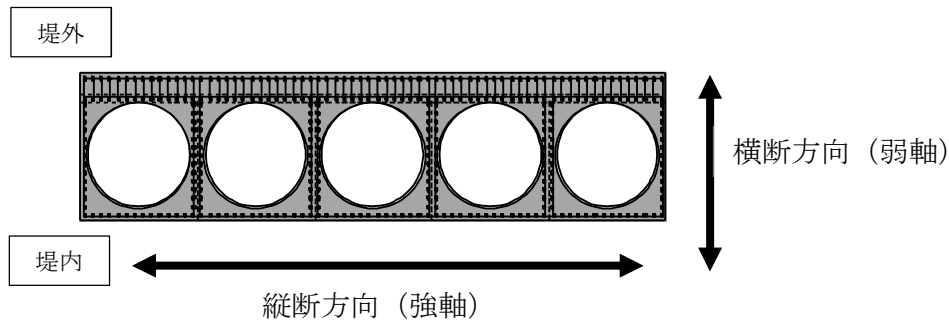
鋼管杭鉄筋コンクリート防潮壁断面図
